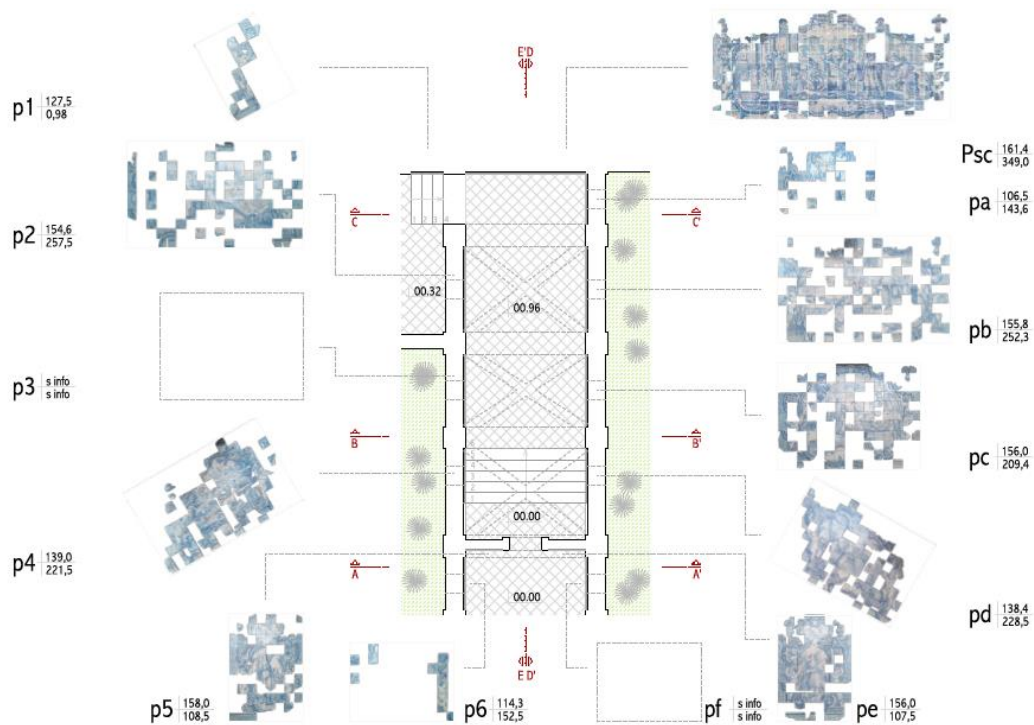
Proposta de planta para possível local de origem dos painéis da série de Santo António. Com a colaboração de João Baptista Lopes.
